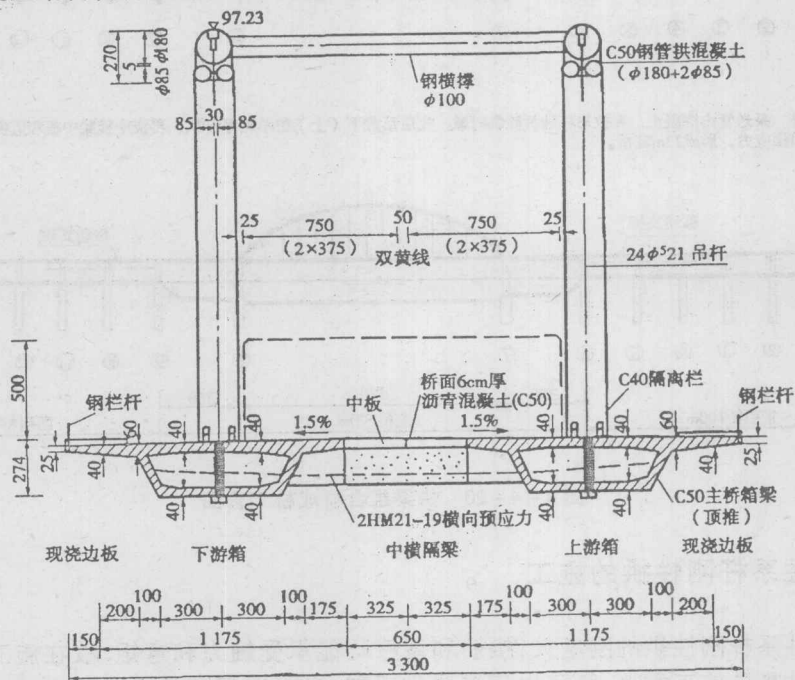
连续拱梁组合体系桥横断面布置(尺寸单位:cm)
